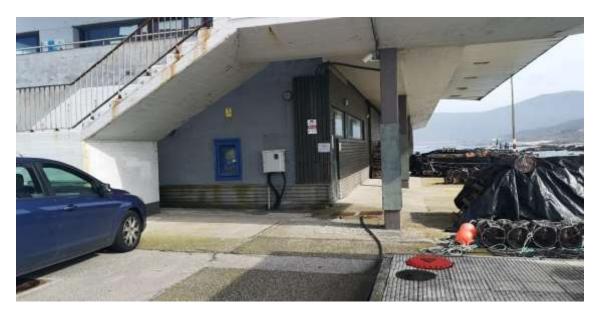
Planta baja de la fachada sur de la lonja. Fuente: ACADAR
